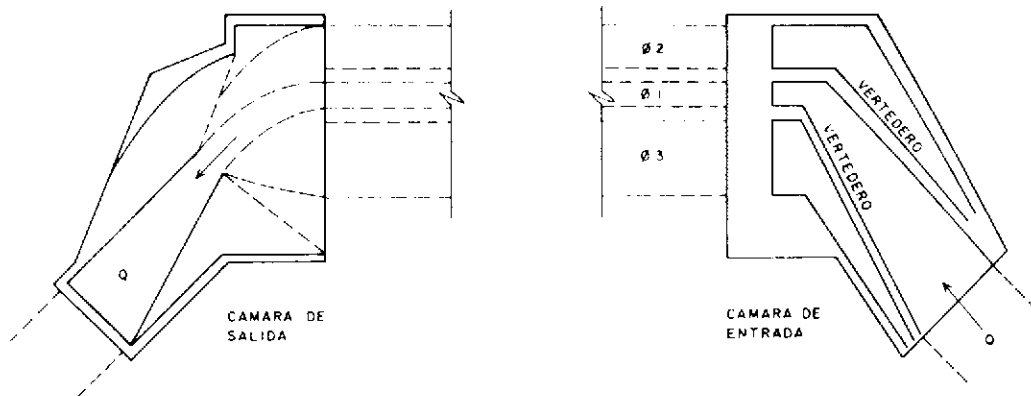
Detalles en planta de las cámaras de entrada y salida.
